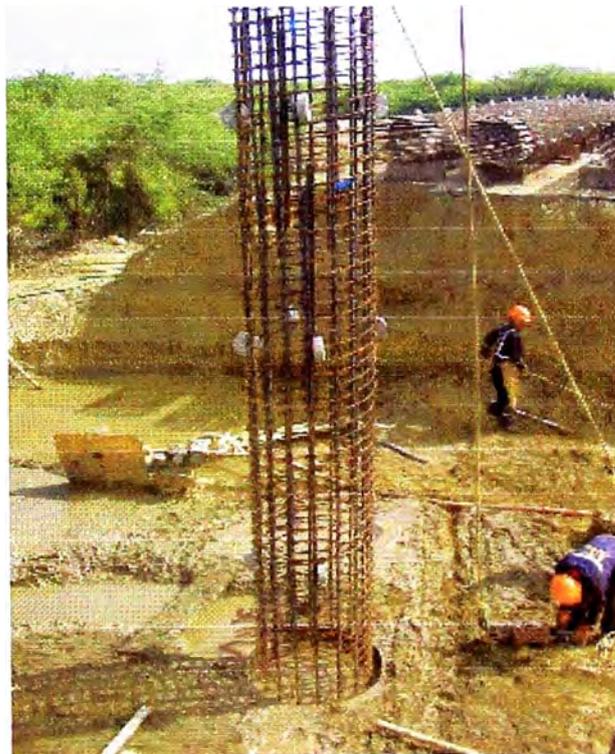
Disposición de los separadores en el refuerzo.
